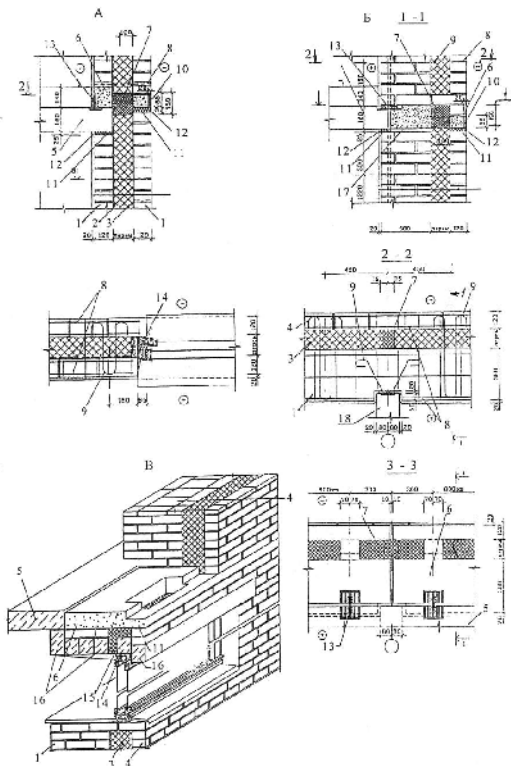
Детали конструкций трехслойных кирпичных стен с опиранием слоя кирпичной кладки на керамзитобетонную фасадную балку: А — с одинаковой толщиной слоя; Б — с утолщенным внутренним слоем; В — ассиметрическая схема установки керамзитобетонной опорной фасадной балки: 1 — внутренний слой кладки, 2 — паронизоляция, 3 — утеплитель, 4 — наружный слой кладки, 5 — плита перекрытия, 6 — керамзитобетонная фасадная балка, 7 — негорючий утеплитель, 8 — сварная сетка, 9 — шпкер, 10 — декоративная плитка, 11 — упругая прокладка, 12 — расшивка раствором, 13 — сварная сетка, 14 — оконный блок, 15 — доска, 16 — железобетонная перемычка, 17 — цементный раствор, 18 — внутренняя стена
